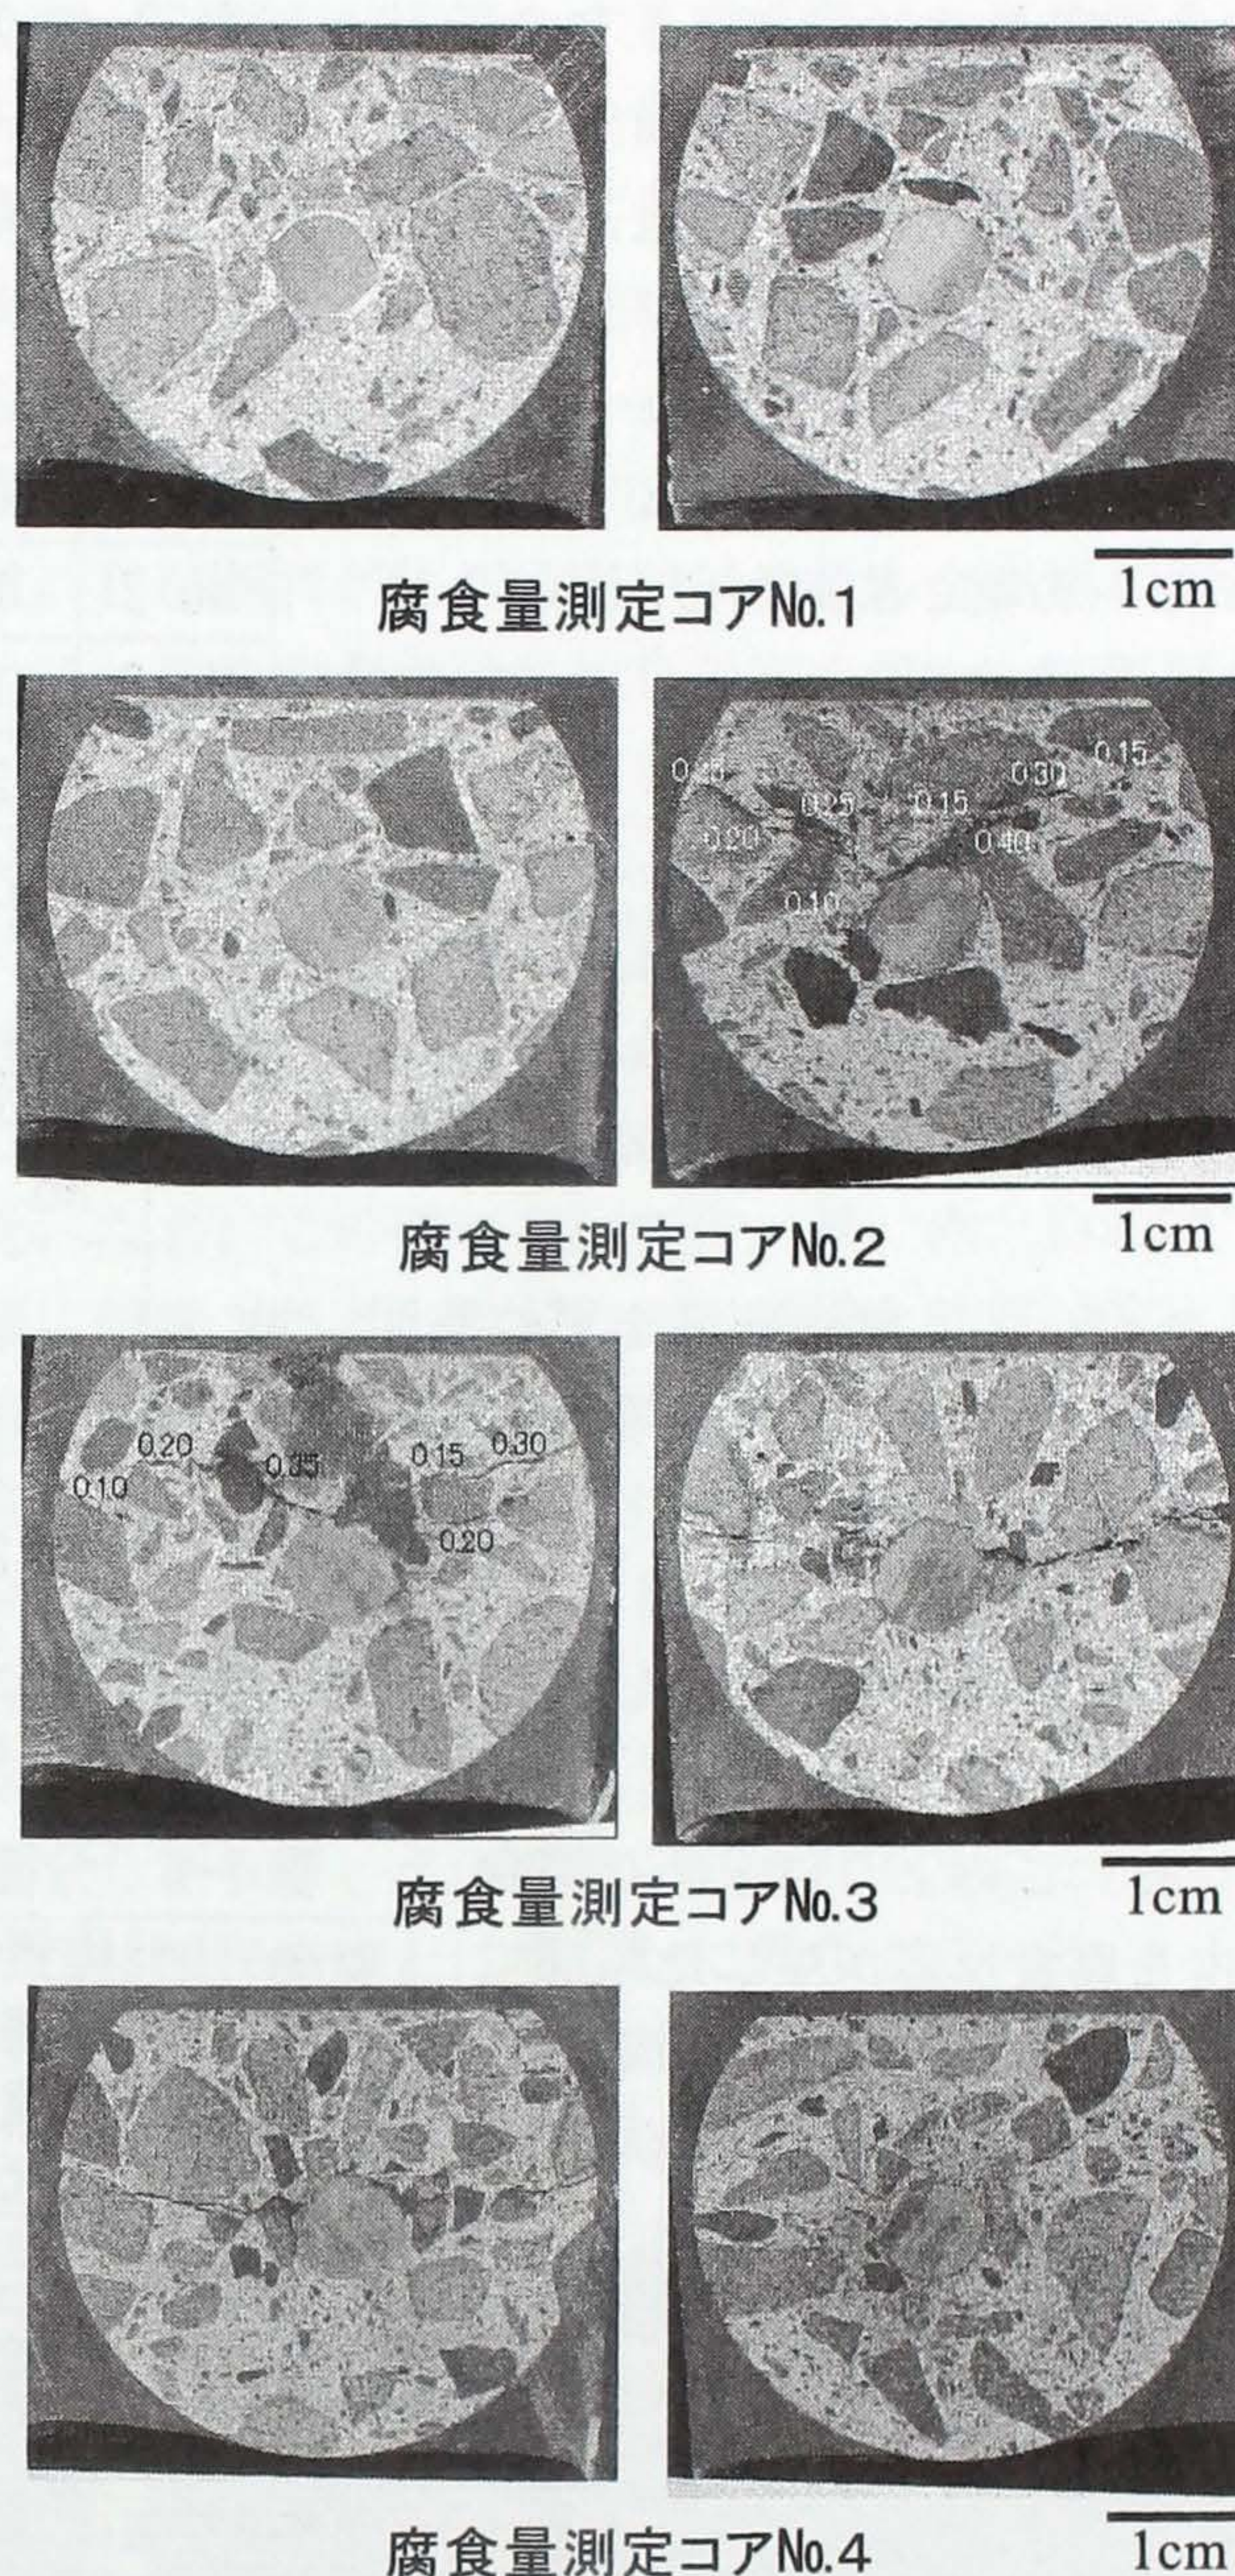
腐食量測定コアの端部のひび割れ発生状況
